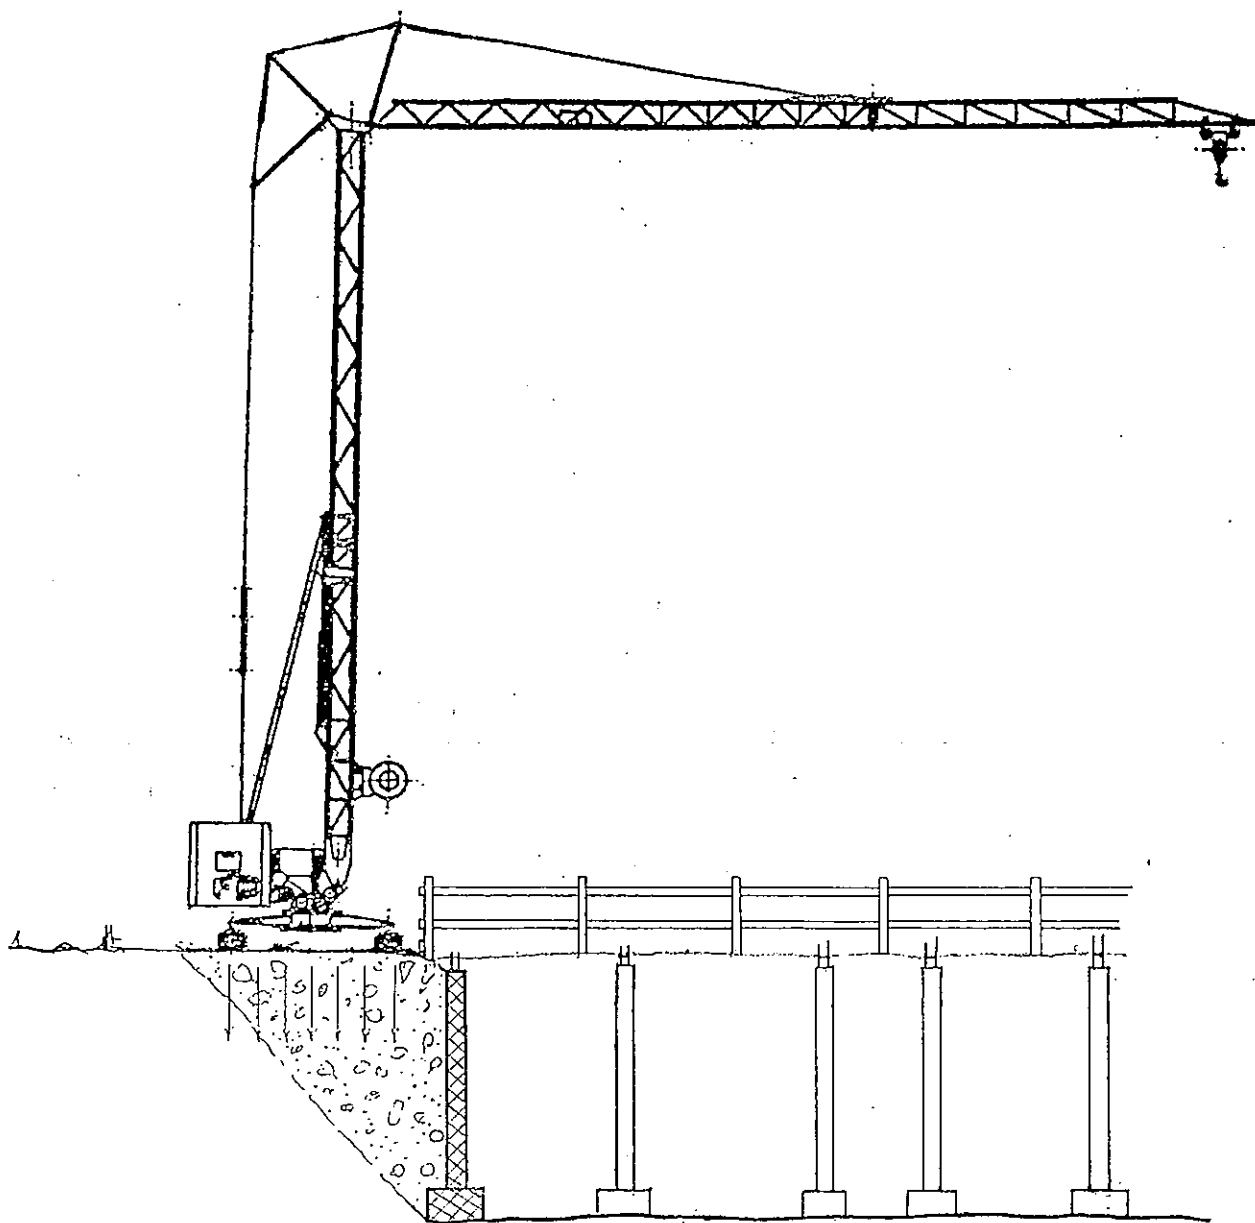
INSTALLAZIONE SICURA DELLA GRU
